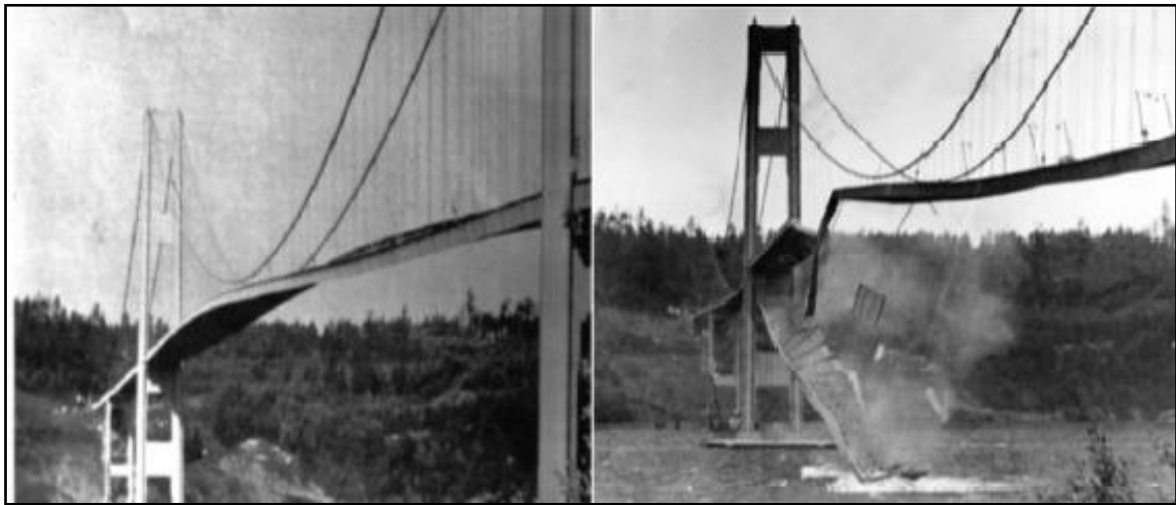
Colapso del puente de Tacoma Narrows en 1940.
